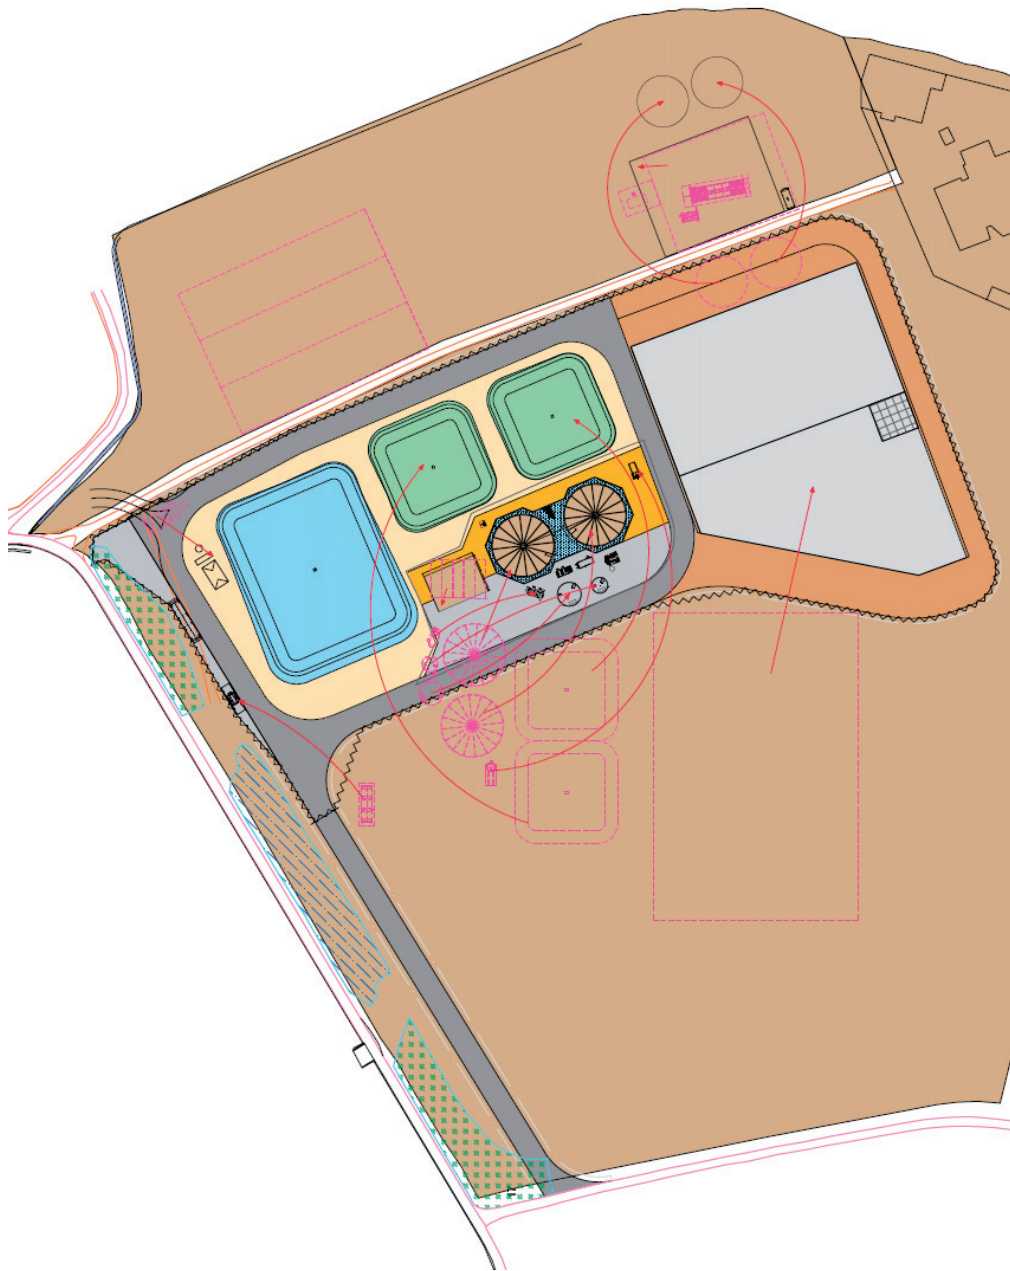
Plano 2 en planta de la instalación. Cambios en la distribución antes y después de la modificación.
